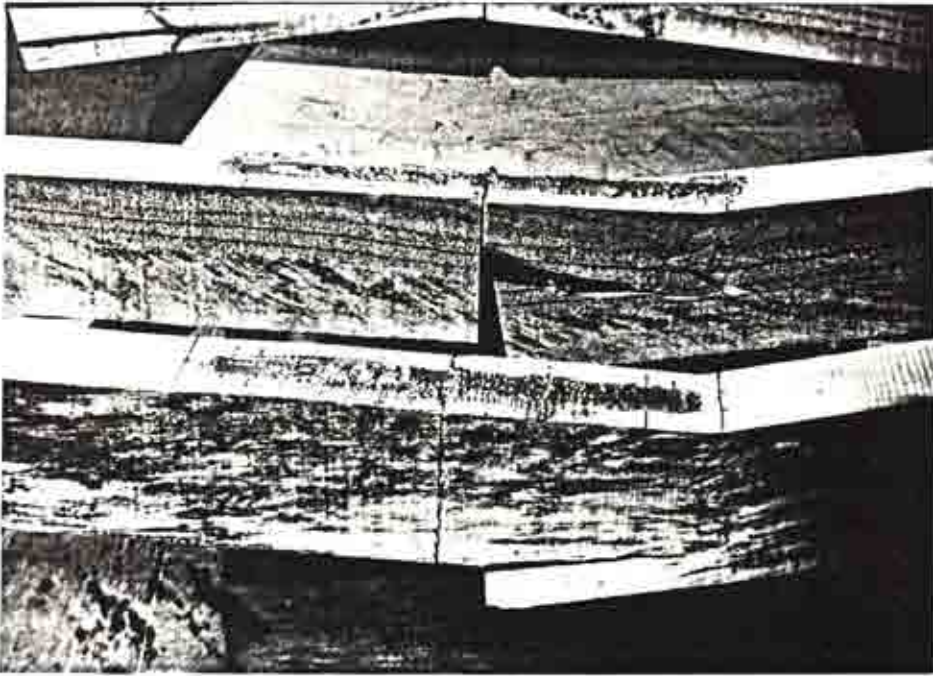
Aspecto de la rotura de vigas unidas en el centro de la luz con placas internas. La superior falla por cortante de la madera y la inferior por flexión de la madera fuera del anclaje de la placa .
